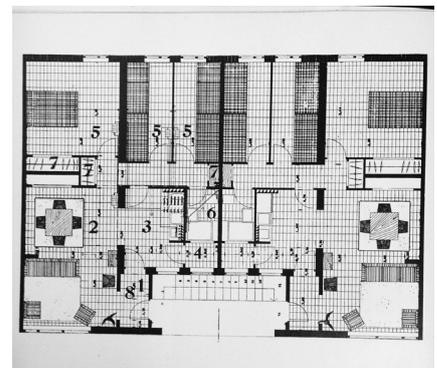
Cubillo. Concurso de Vivienda Experimental. Planta tipo de la vivienda colectiva en el bloque de cuatro plantas. Madrid, 1956.
